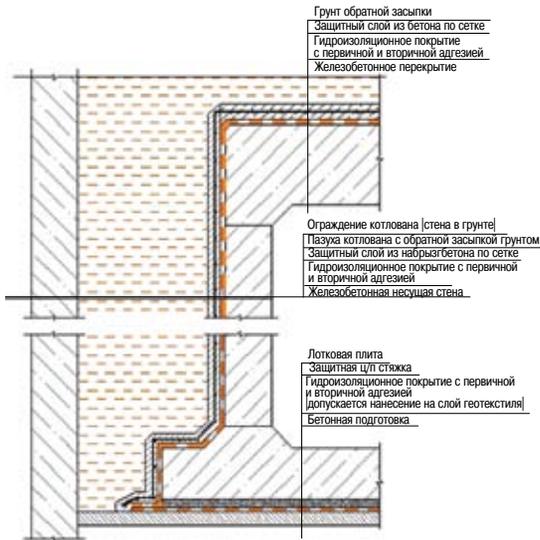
Схема устройства гидроизоляционной системы при открытом способе работ с пазухами для обратной засыпки грунтом
